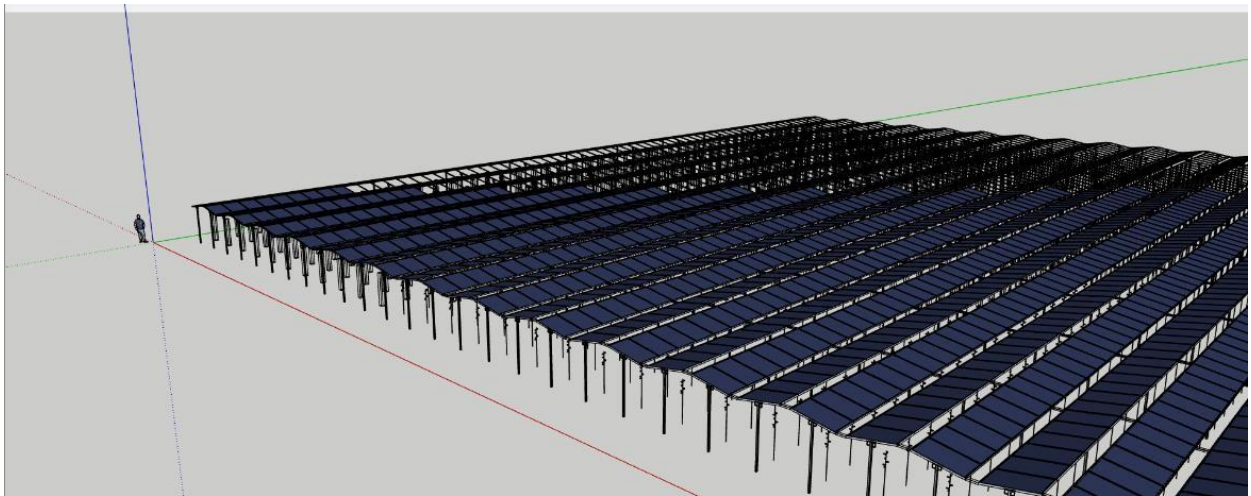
Vue d'ensemble d'une première idée de l'installation projetée. Vue du haut.
